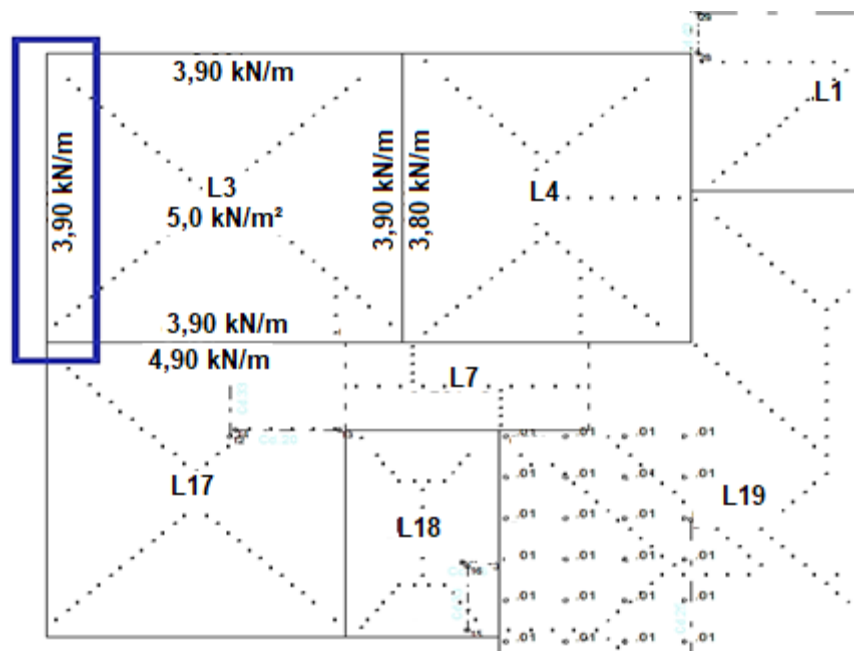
Distribuição das cargas da laje do pavimento tipo.
